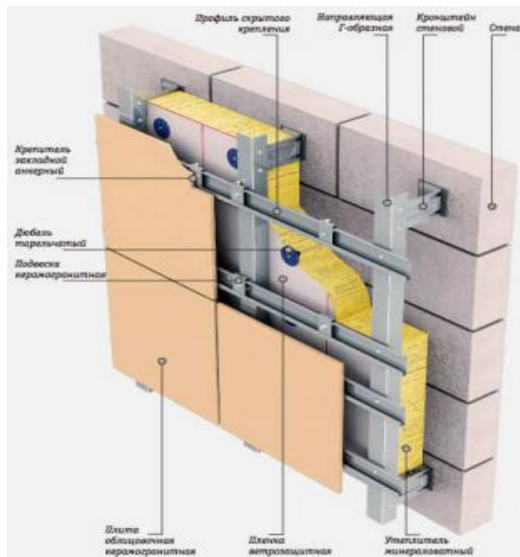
Конструкція навісного вентиляваного фасаду (НВФ)
